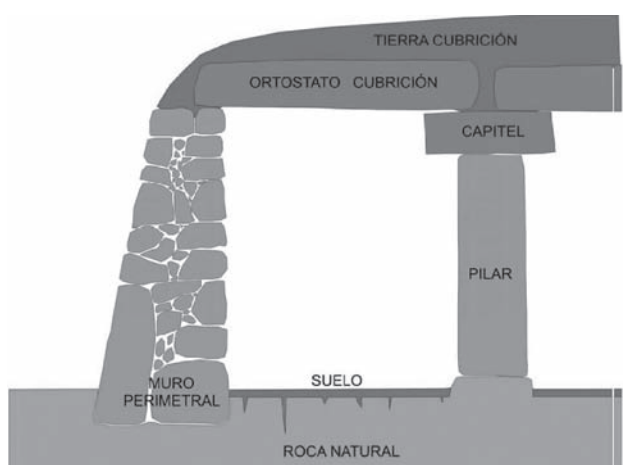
Reconstrucción hipotética de la vivienda talayótica, en la parte oeste, construida totalmente exenta. Sobre los muros de piedra podría haberse levantado una cubierta de piedra o vegetal y, sobre ella, un recubrimiento arcilloso para hacerlo impermeable. Dibujo de Fco. J. López Fraile.
